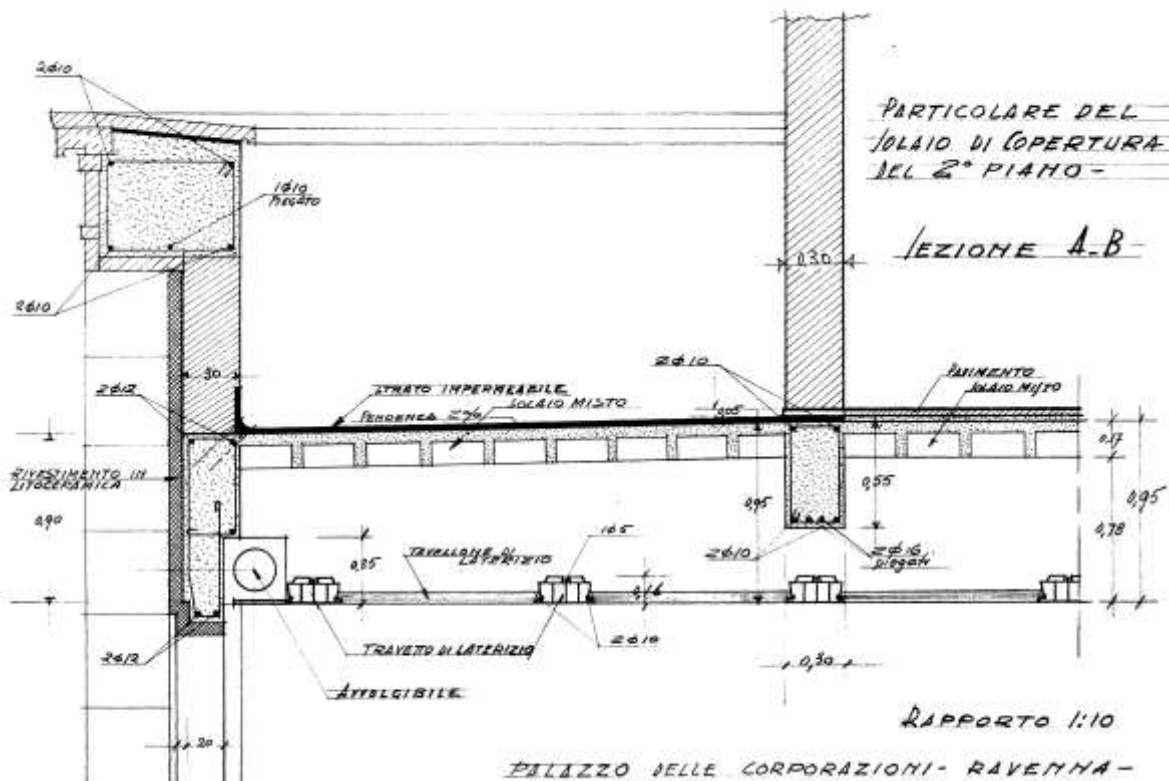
Piano terzo: particolare della controsoffittatura, come prevista da progetto preliminare.
